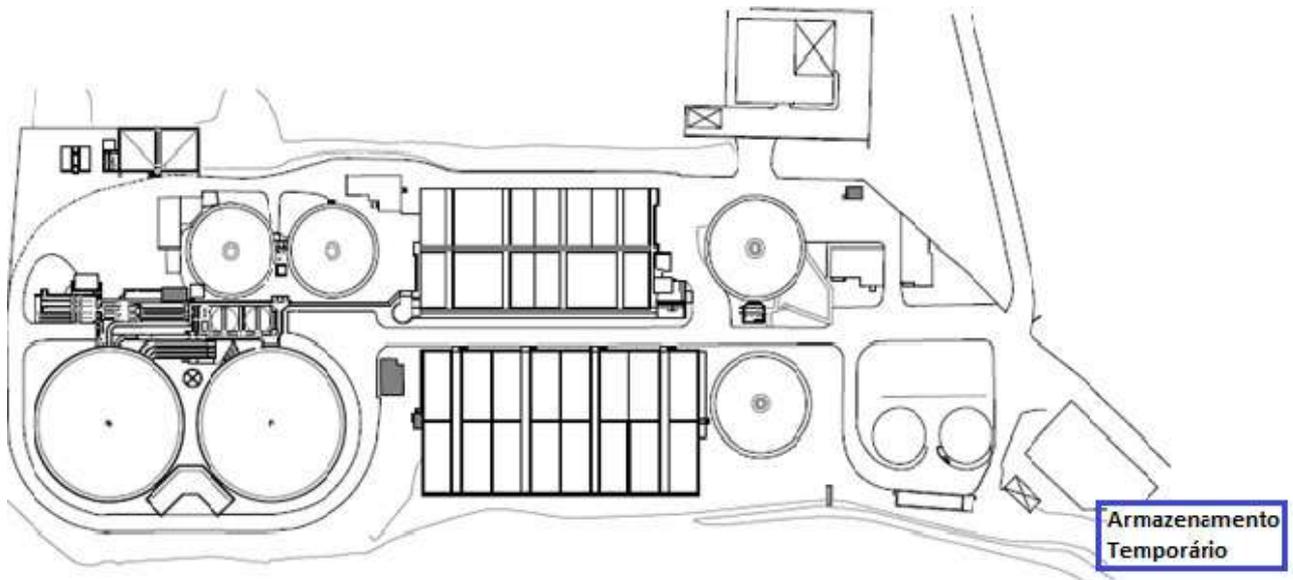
Localização prevista para o armazenamento de lamas a estabilizar.
